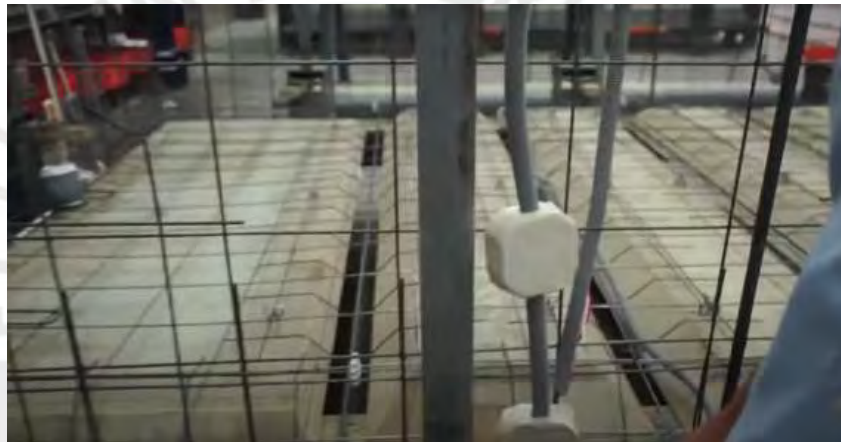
Acero de refuerzo - encofrado losa nervada - tuberías
